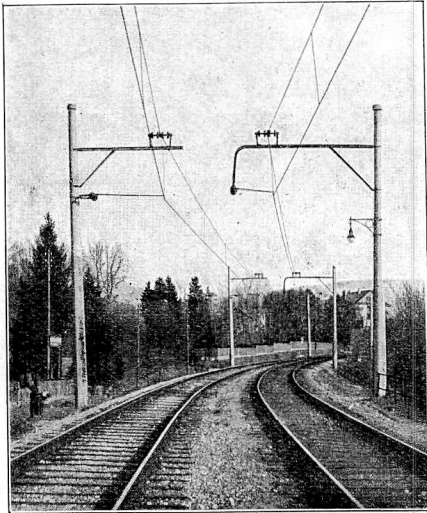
Schleuderbetonmast als Tragvorrichtung der elektrischen Streckenausrüstung Starnberg—Tutzing.
